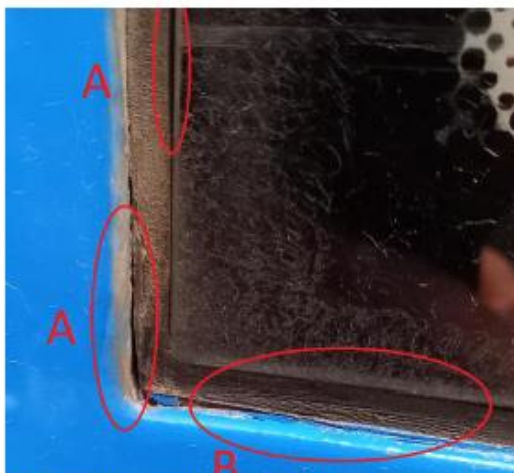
Gedegradeerde kitnaad. A) kieren door loslaten kit. B) barstjes in kitnaad.
